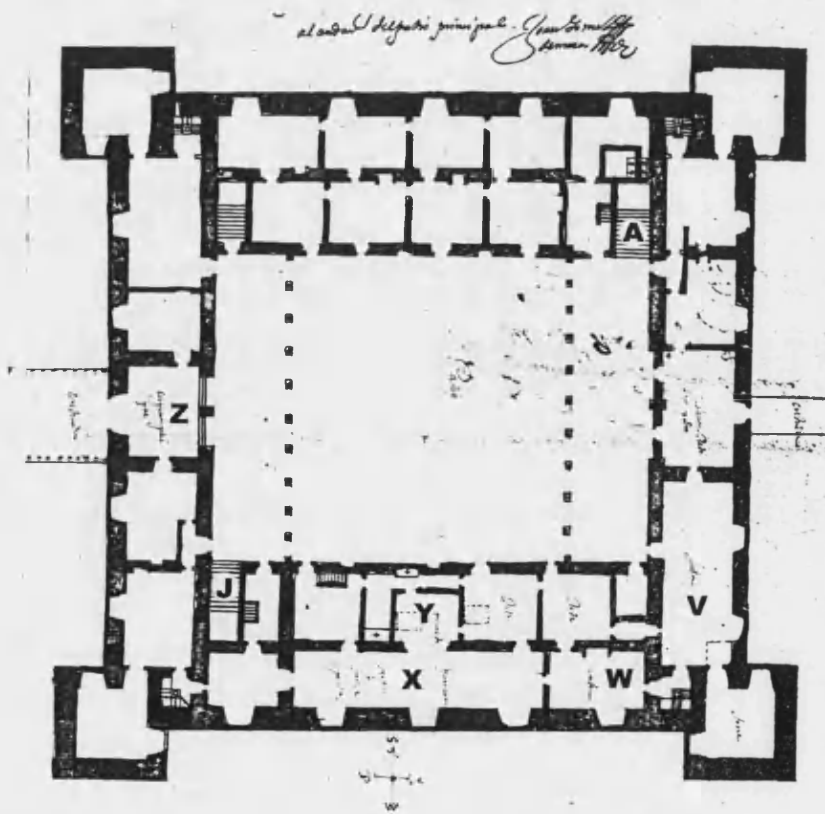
Juan Gómez de Mora. *Planta baja de El Pardo. 1626.* Biblioteca Vaticana.
